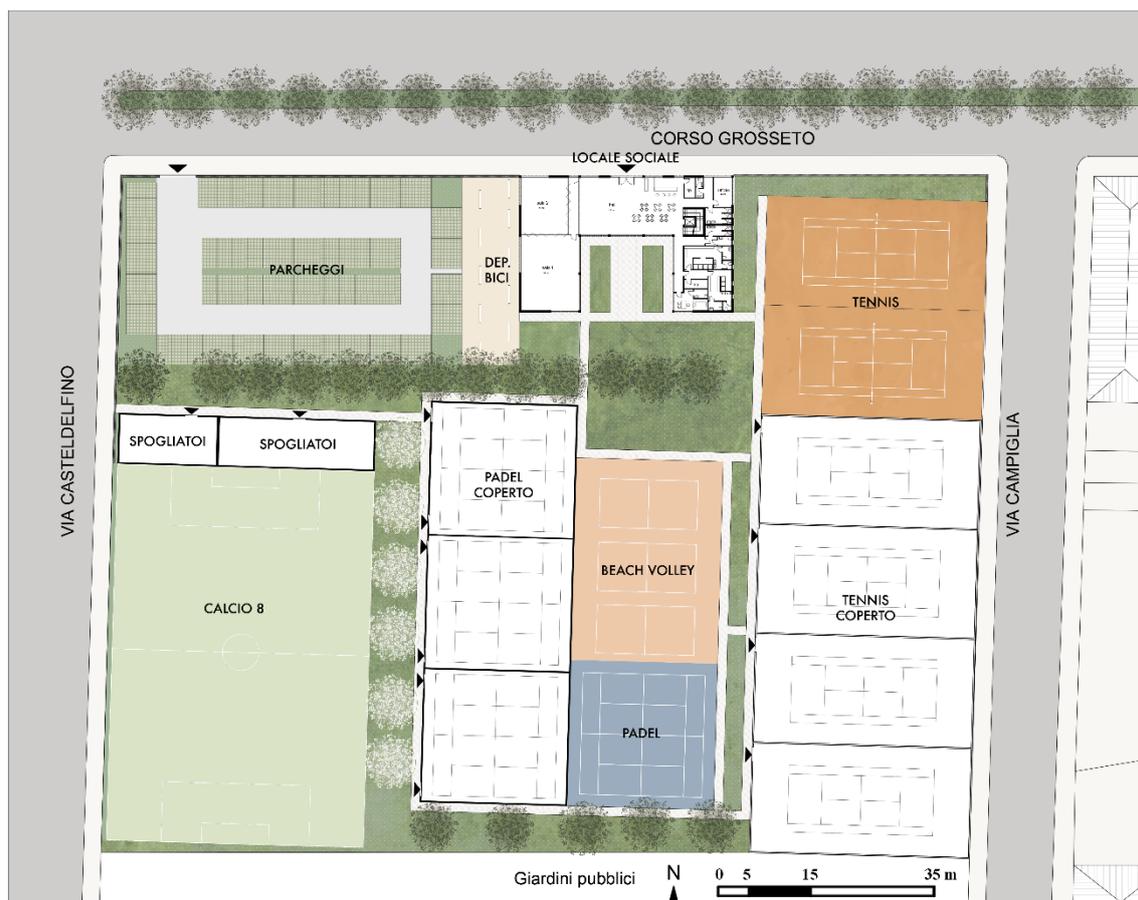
Planimetria relativa alla FASE 3 di realizzazione del centro sportivo
